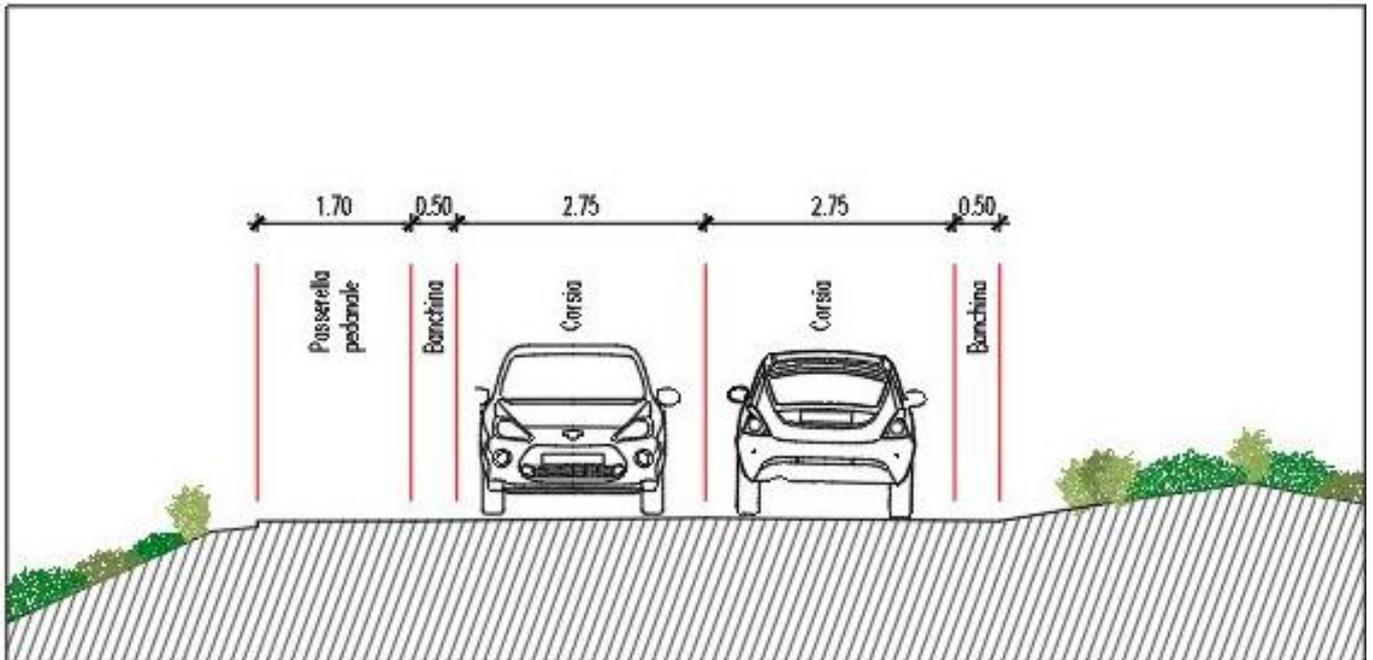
Sezione tipo lato parcheggio Fontanamare
